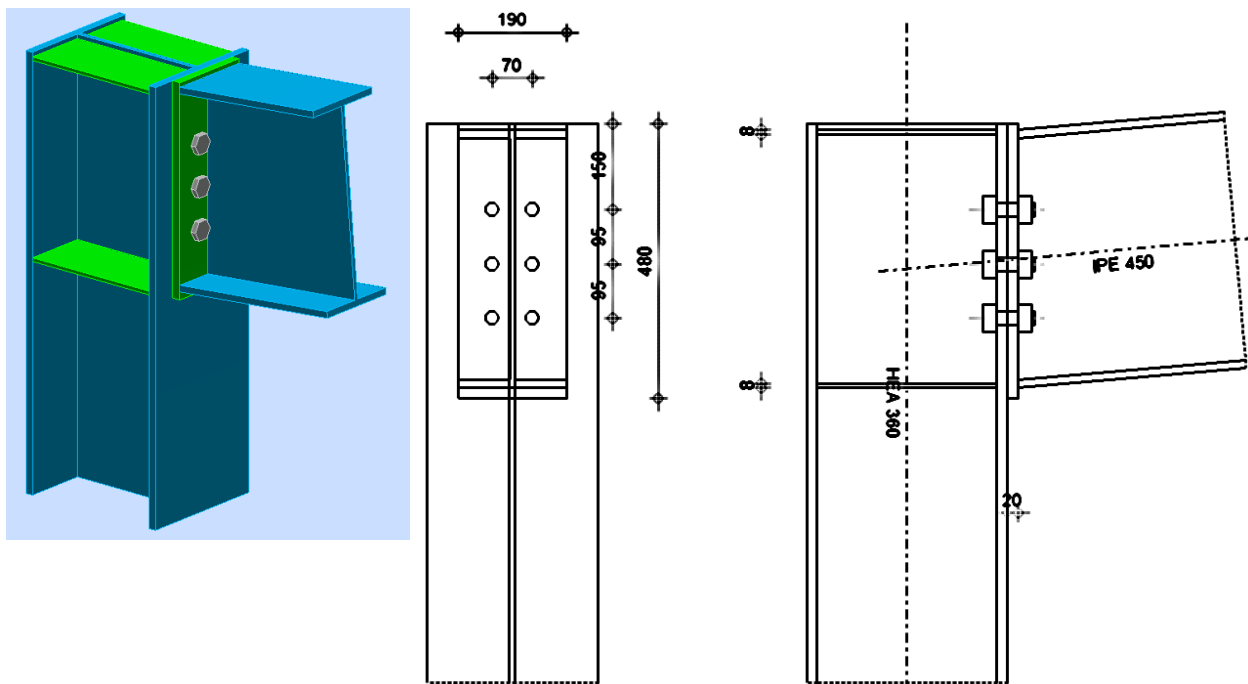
Representação da ligação entre o pilar e a travessa para o pórtico tipo 2
